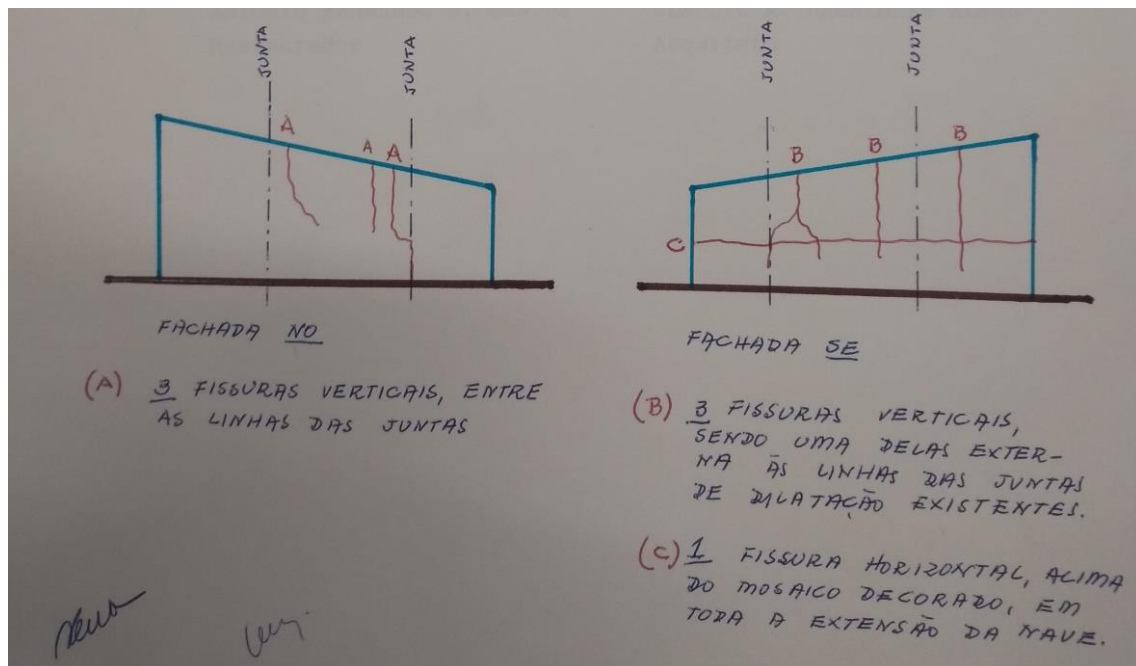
Croquis das fissuras observadas em abril de 1993. Fonte: IPHAN/MG.
